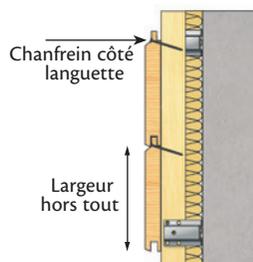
Fixation non apparente (lame \leq 125 mm)
